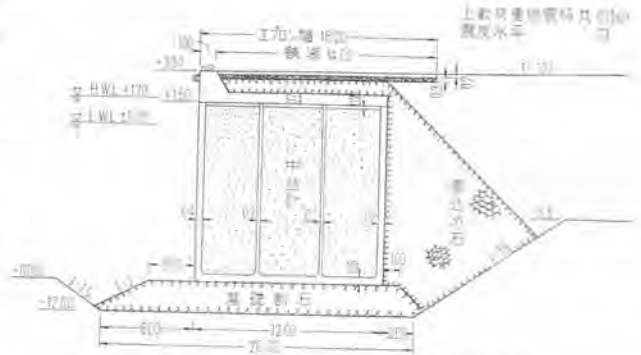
興津第二ふ頭東側岸壁(-10 m)標準断面図
